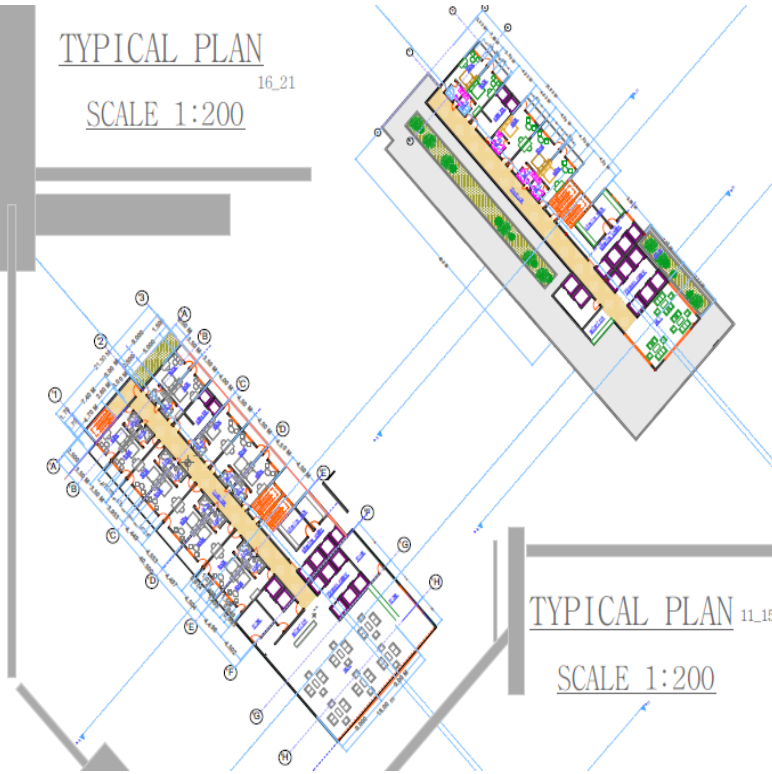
الفكرة المبدئية ROOM FLOORS
